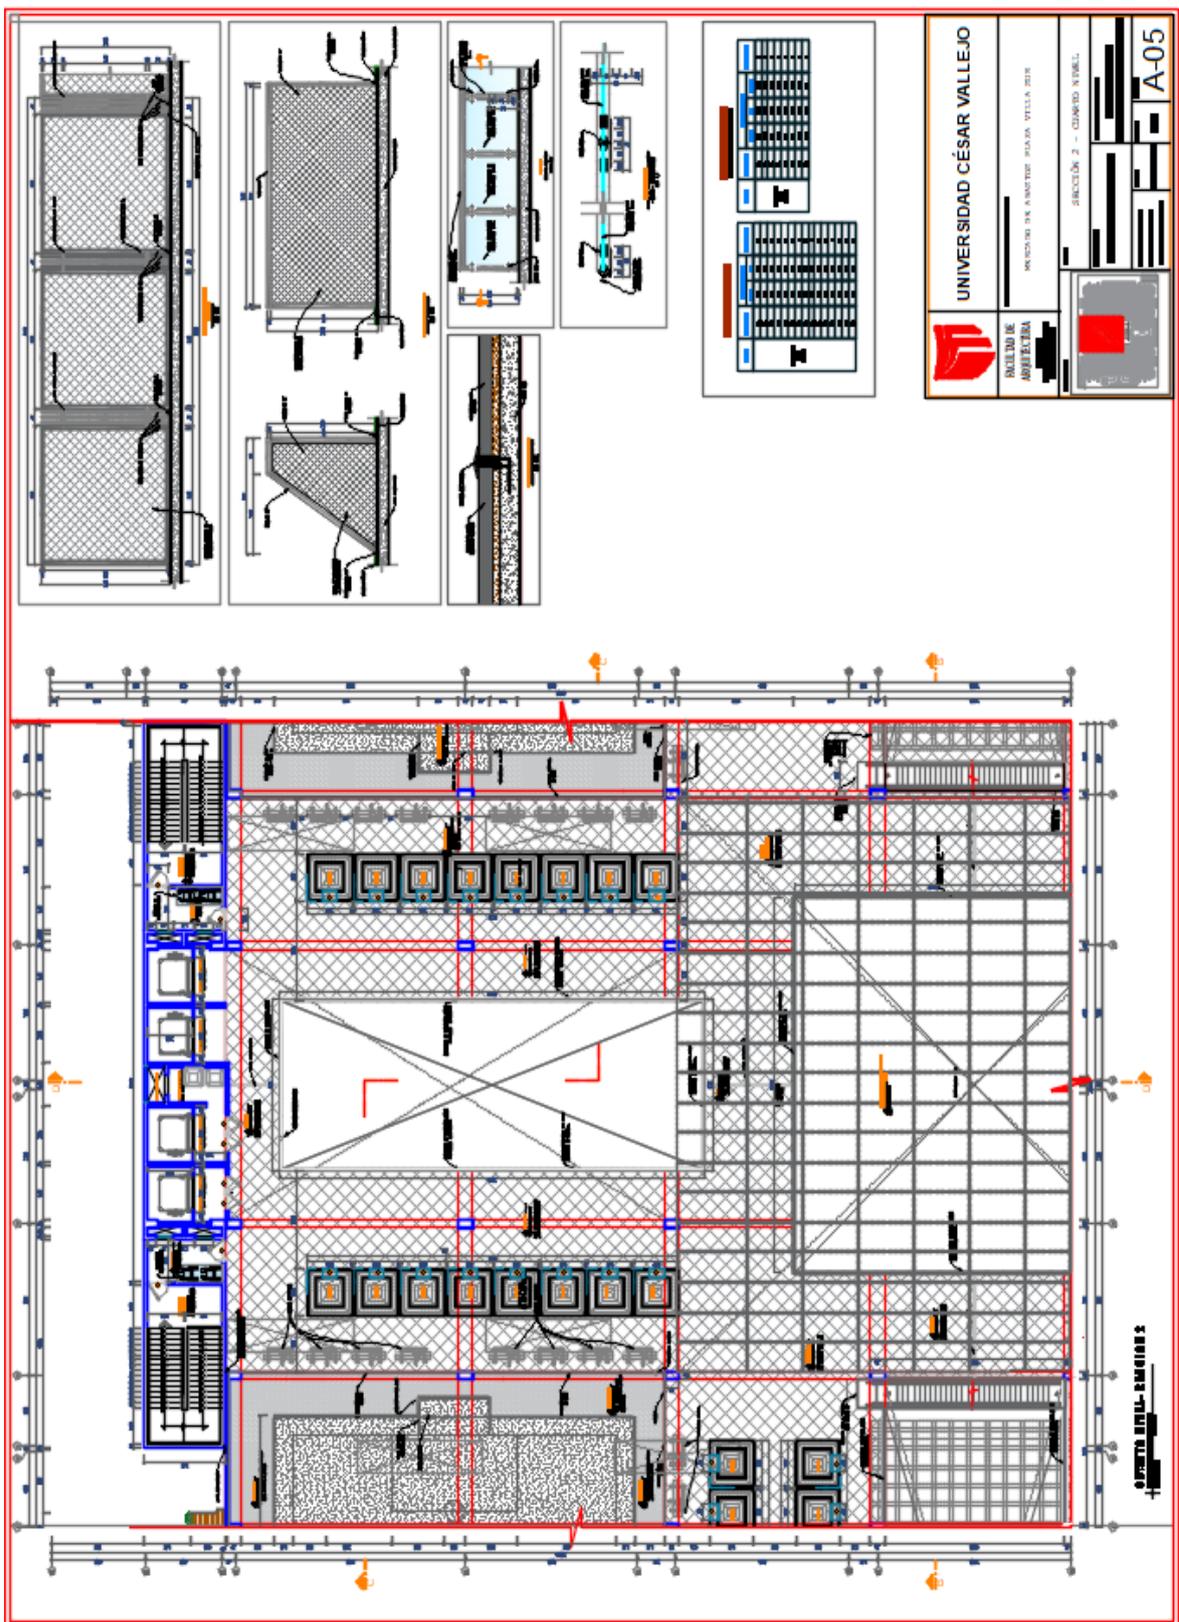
Plano de Arquitectura – Plano de secciones – cuarto piso
